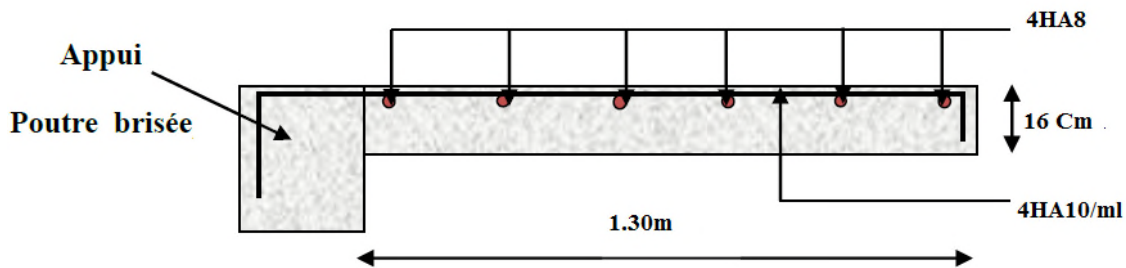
Schéma de ferrailage des volées de l'escalier balancier
